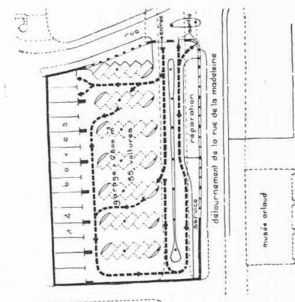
Plan du garage. — Echelle 1 : 2000.
